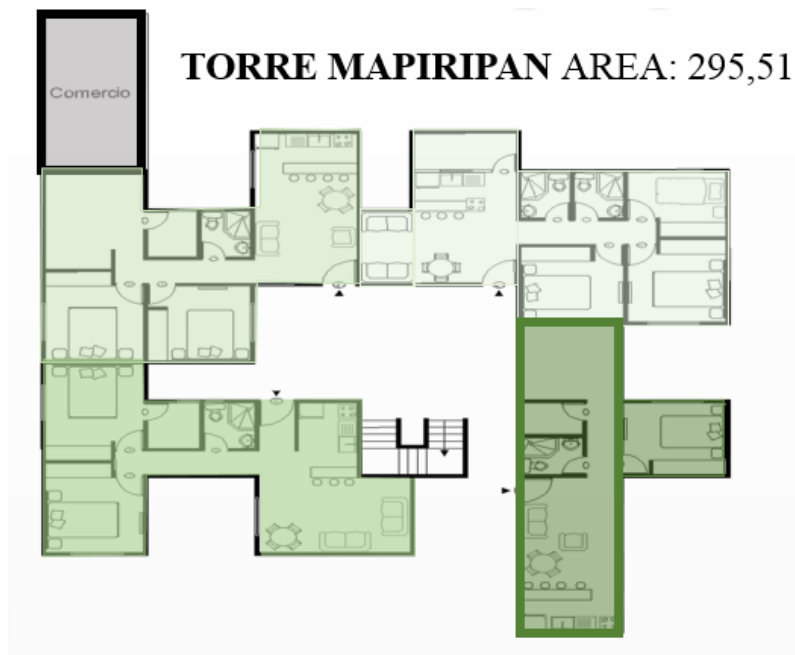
Planta arquitectónica del primer piso en la Torre Mapiripan, con cuatro apartamentos y zona comercial
